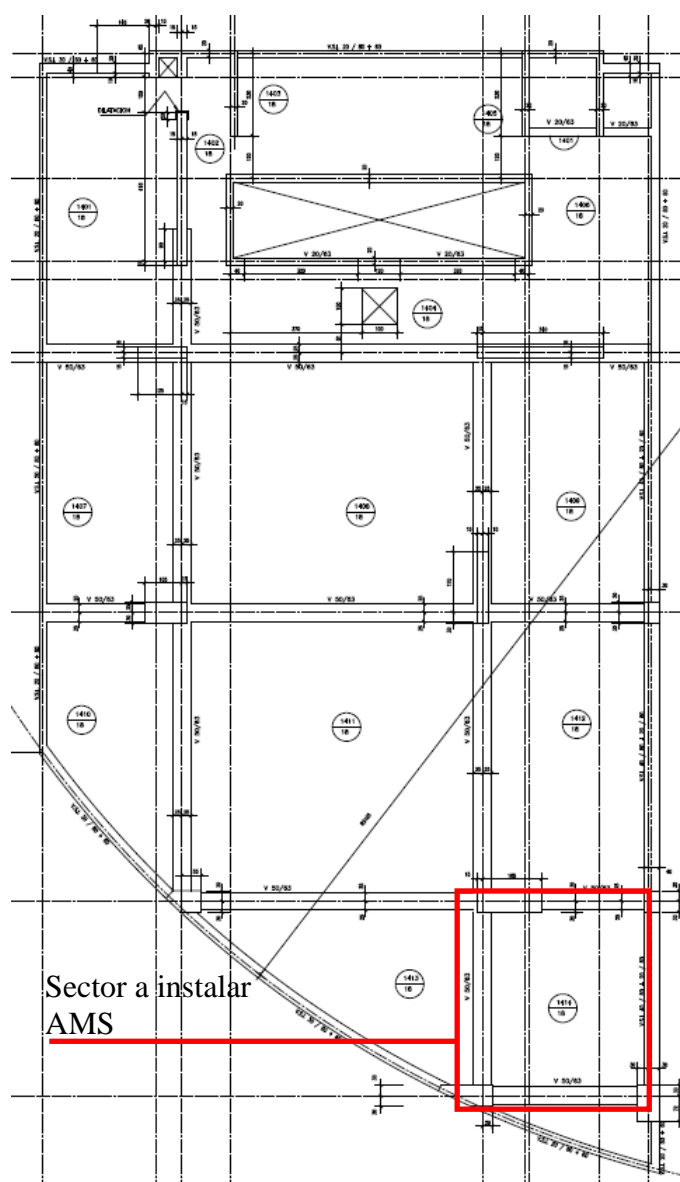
Ubicación en planta AMS. Elevación 48.05m (azotea)
